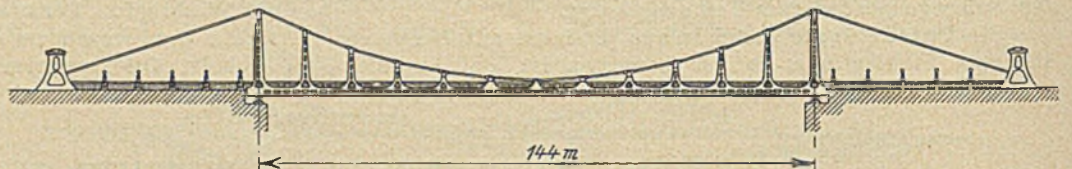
Hängebrücke, System Vierendeel, Versteifungsträger in Eisenbeton.
